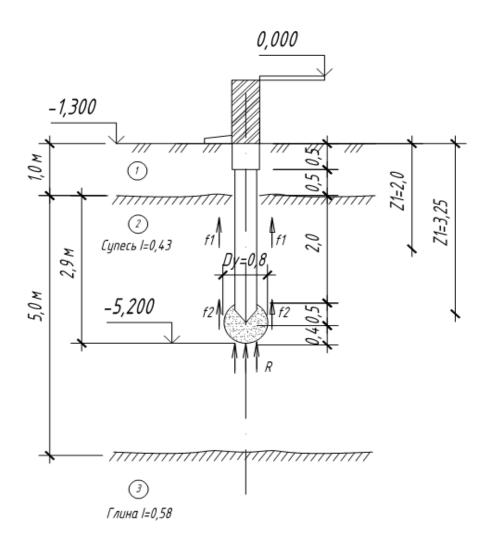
Разрез грунтовой толщи по СПС
